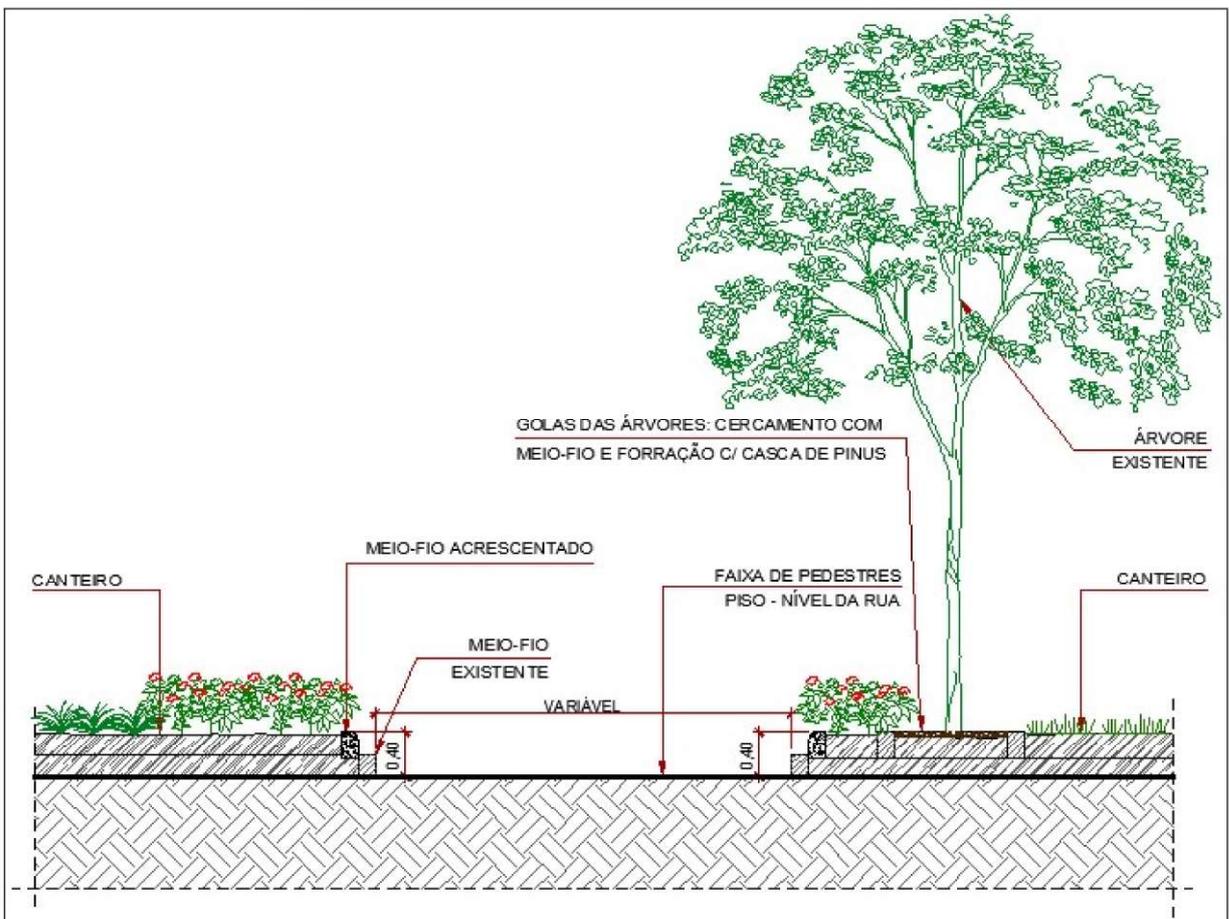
detalhe (seção longitudinal) de um trecho com faixa de pedestres entre canteiros (fonte: Serpenge)
